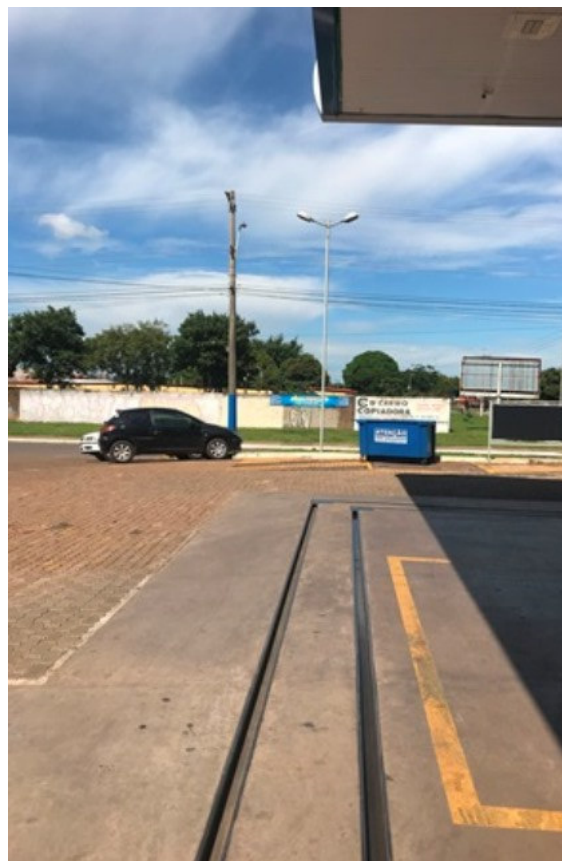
Canaletas do sistema de drenagem oleosa com o devido
